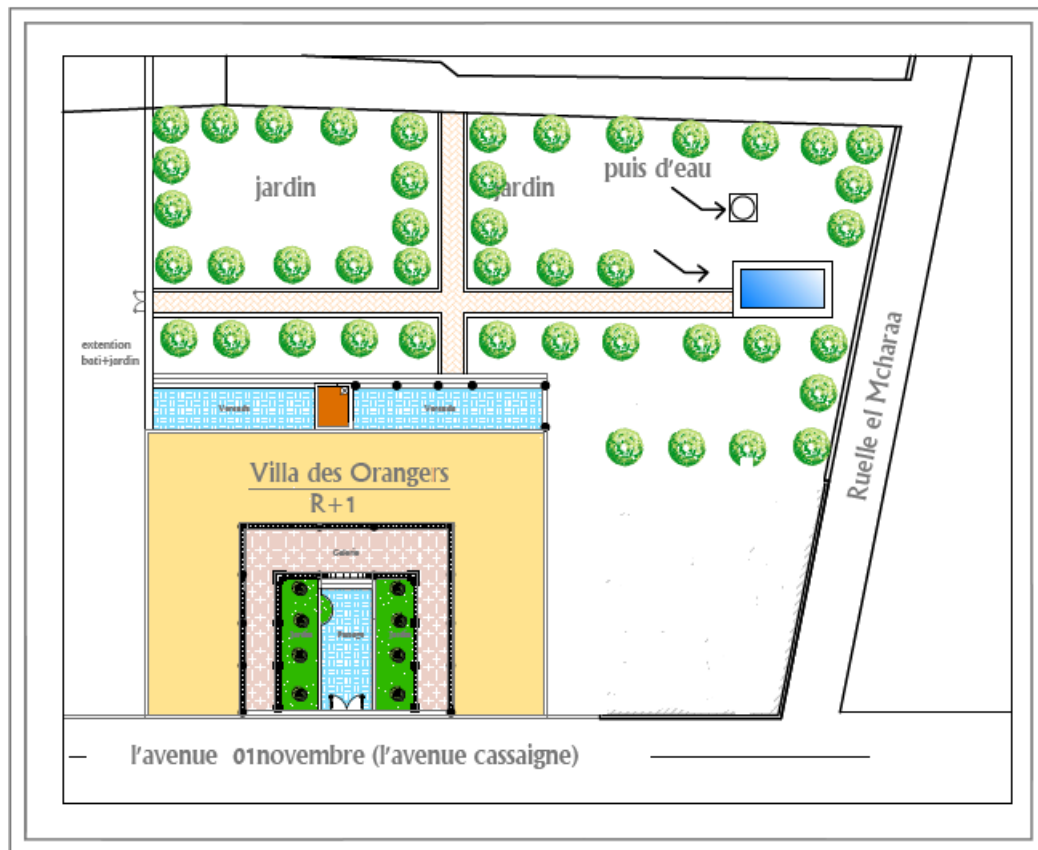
Plan de masse de la villa de l'Orangerie, source: auteur
